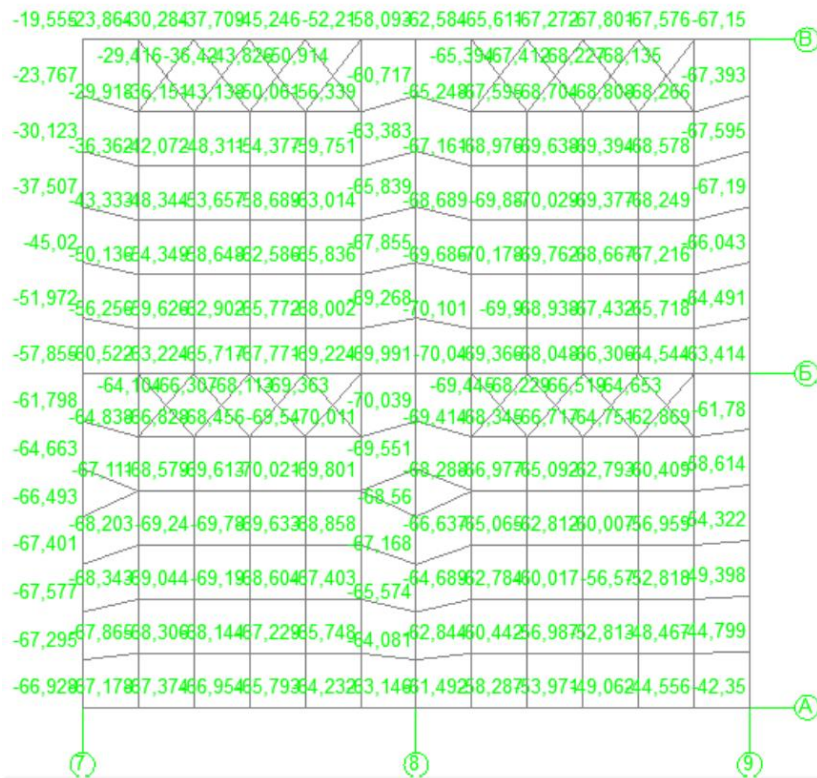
Фрагмент перекрытия с максимальными перемещениями по оси Z
